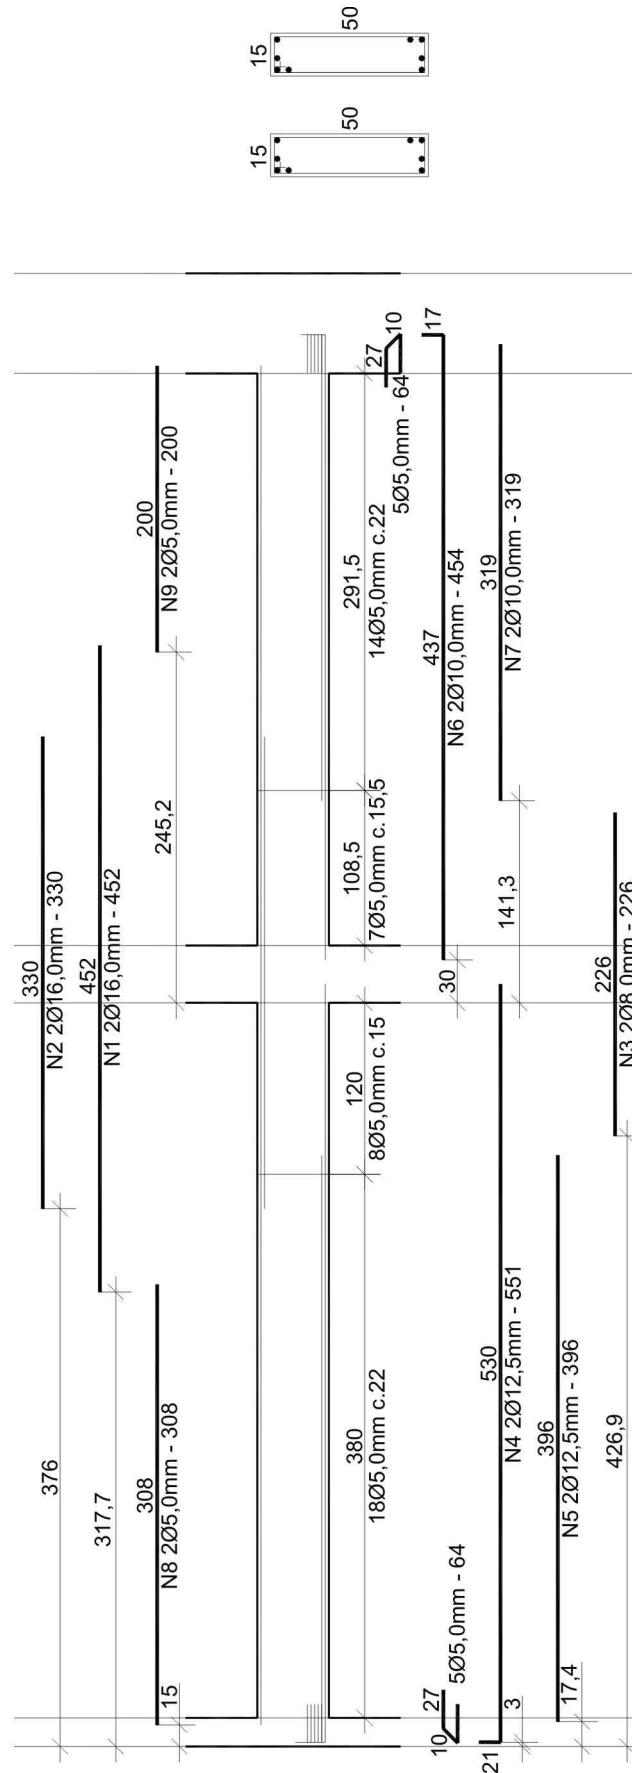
Detalhamento Viga 03.9, realizado pelo VigaCalc.
